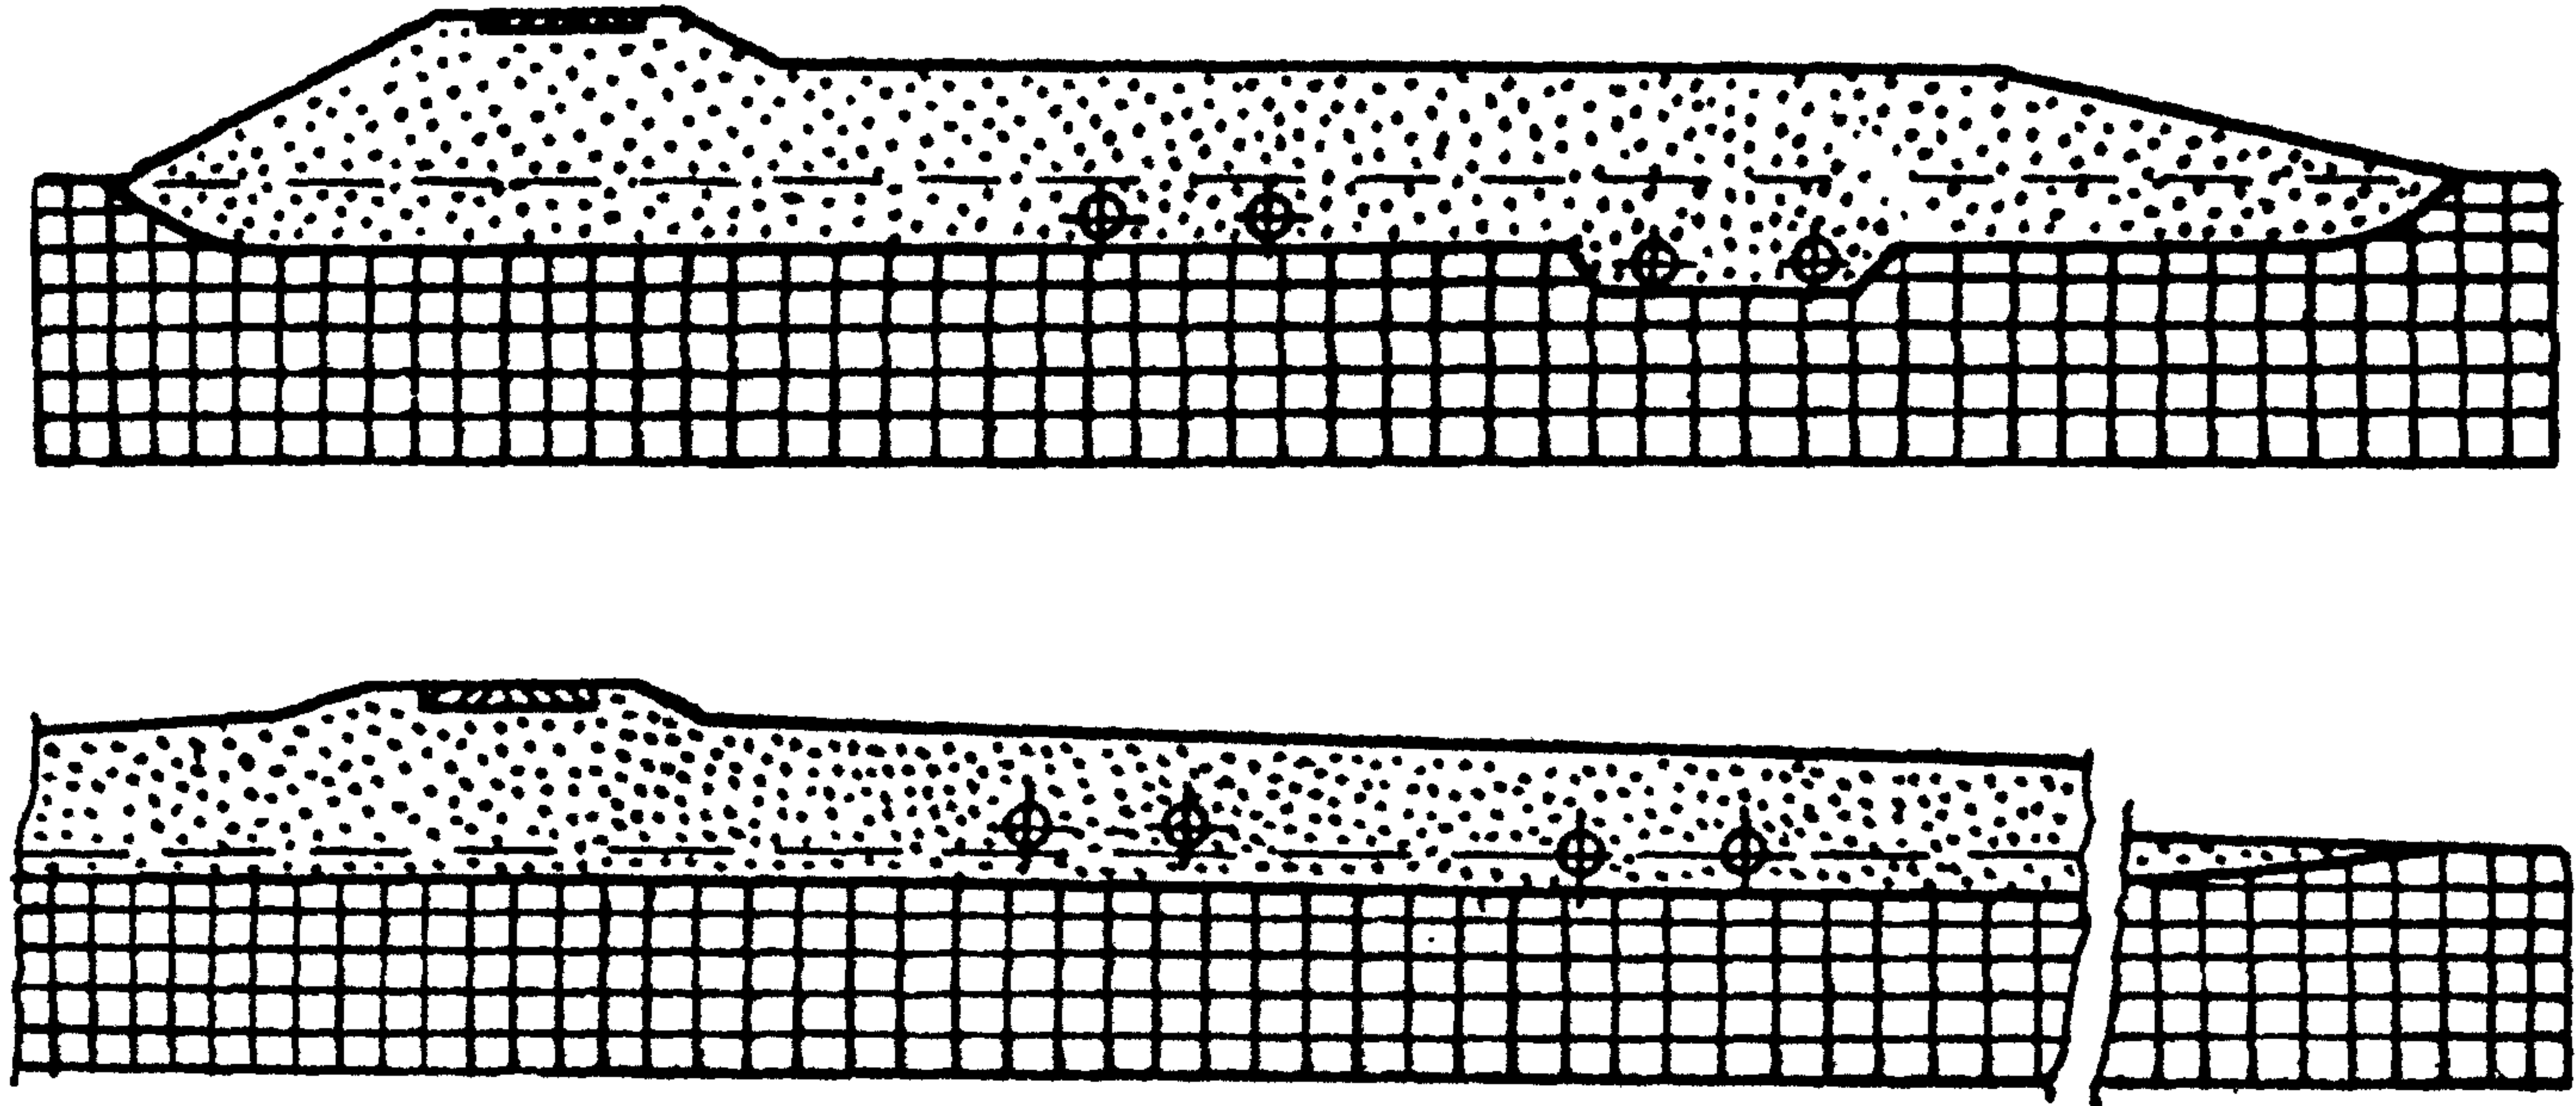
Схемы совмещенного способа прокладки автодорог и трубопроводов
